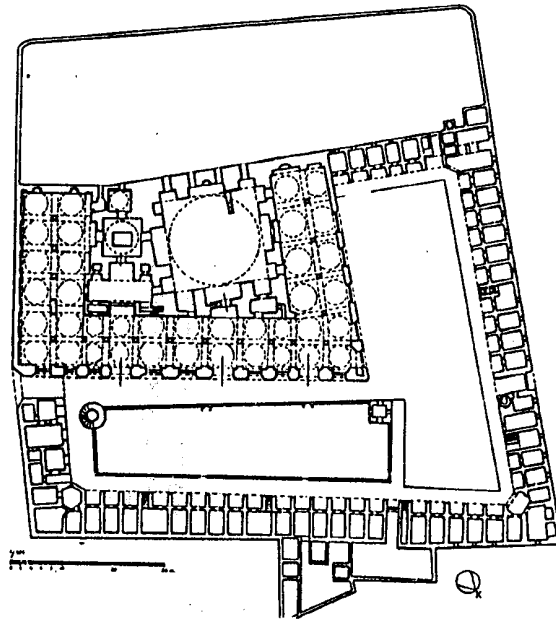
مسقط أفقي لمسجد صلحة بصنعاء اليمن (عن ، Serjnet)
